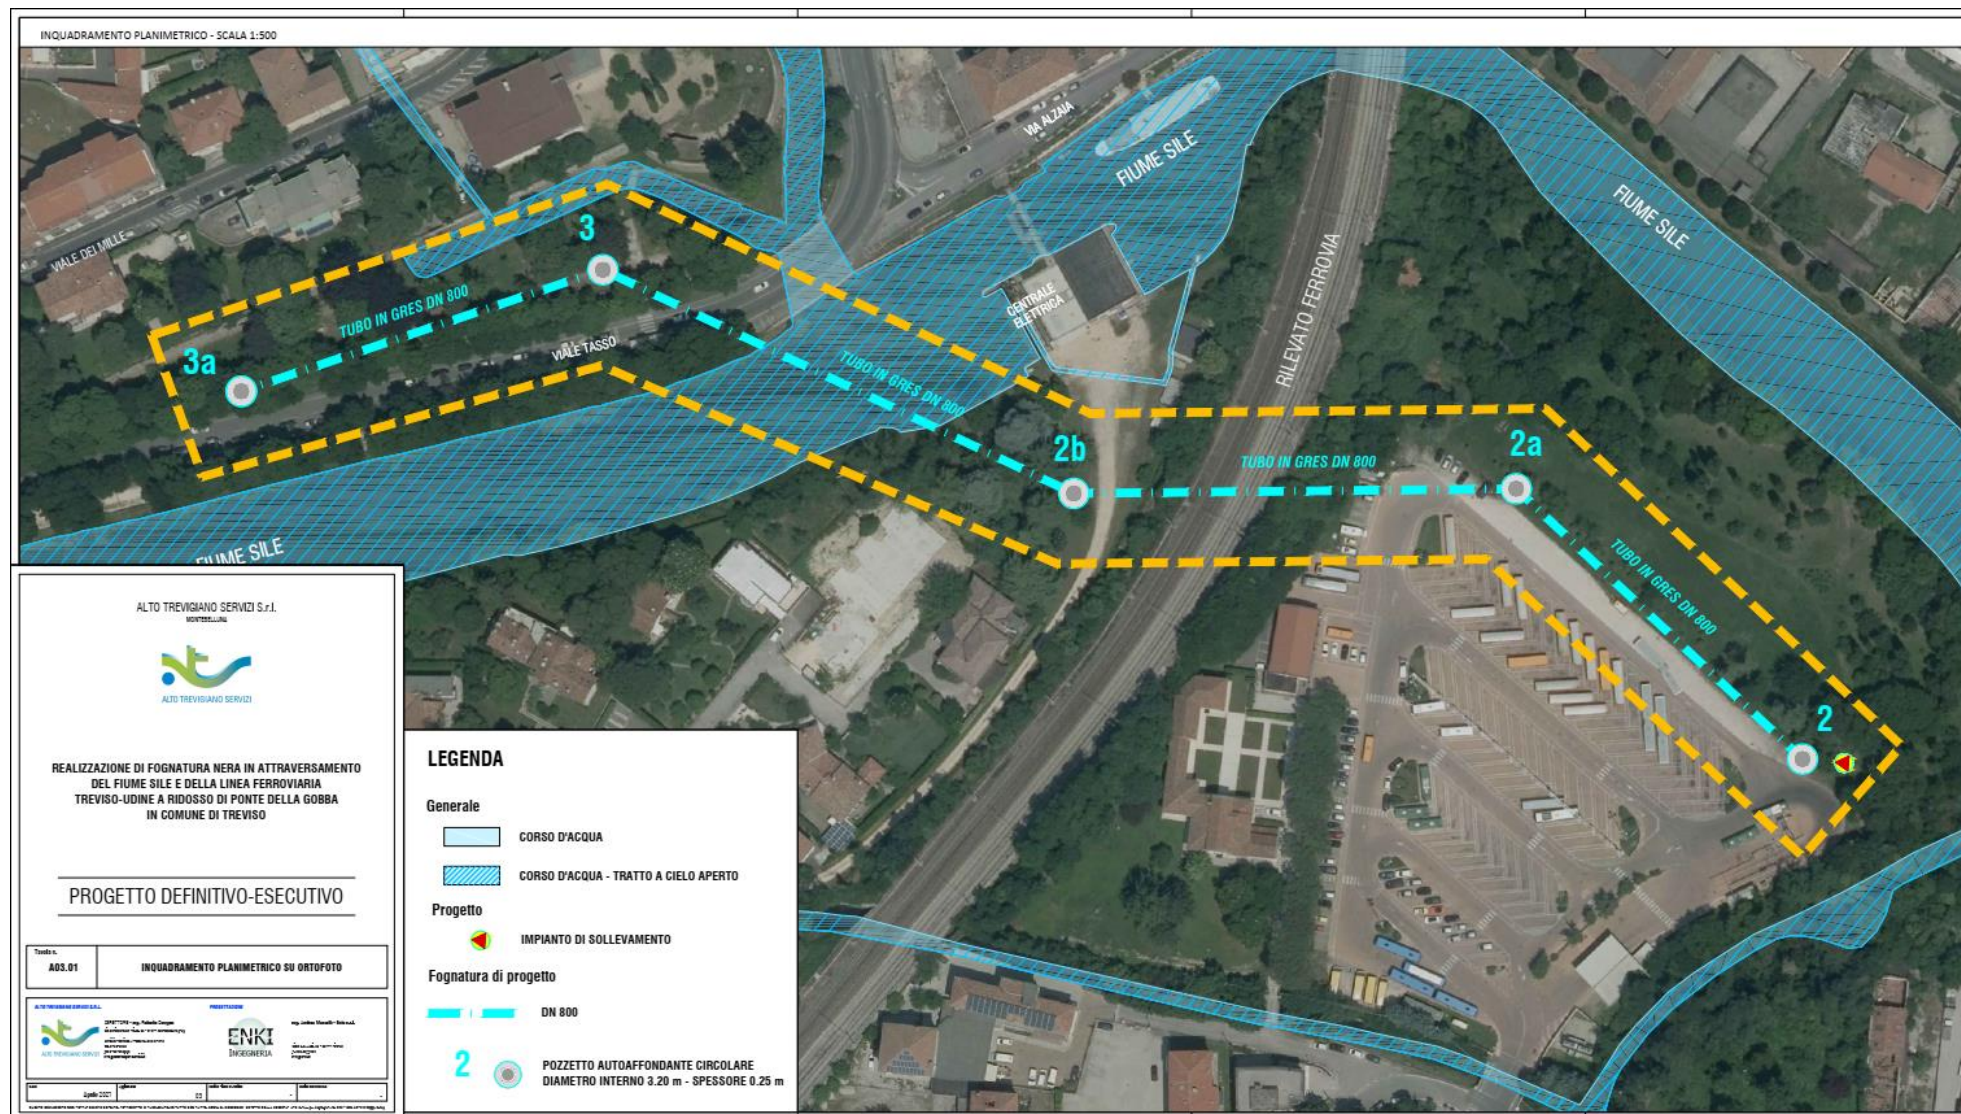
C : Estratto planimetrico giaciture condotte microtunnelling
